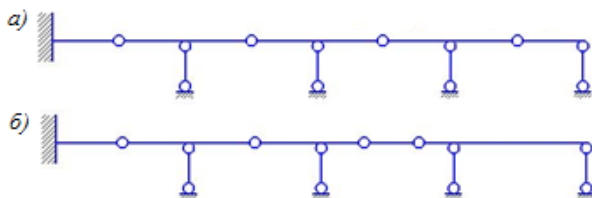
Расчетные схемы многопролетной шарнирной балки с одним заделанным концом
